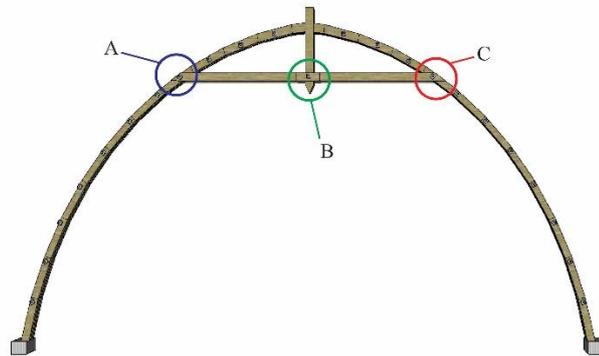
84 Detail F pada sambungan kepala bangunan pada zona I
